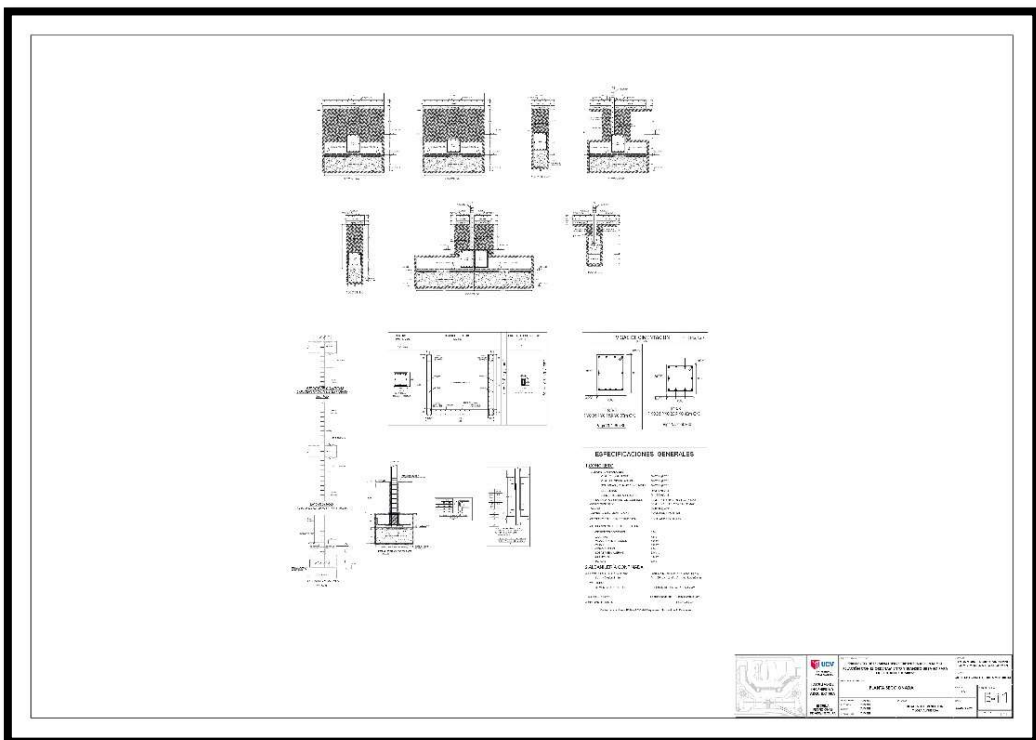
Plano Detalles de Cimientos. Fuente: Elaboración Propia
